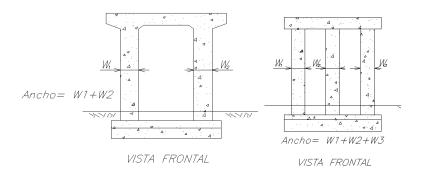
Dimensiones de ancho de columna de Bastión y Pila tipo marco rígido y Pila tipo columna múltiple
